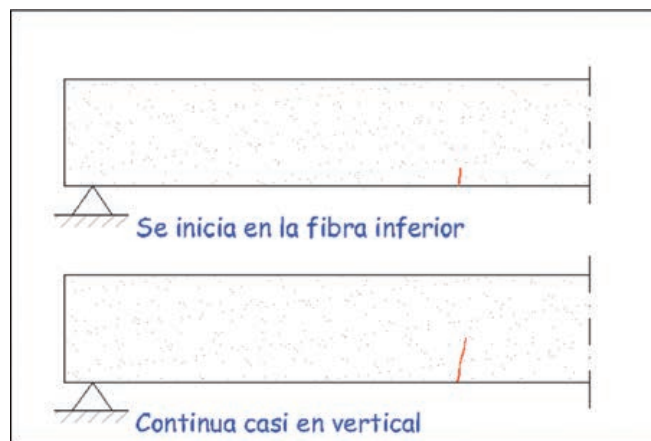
ESQUEMA DE EVOLUCIÓN DE LAS FISURAS POR FLEXIÓN.
